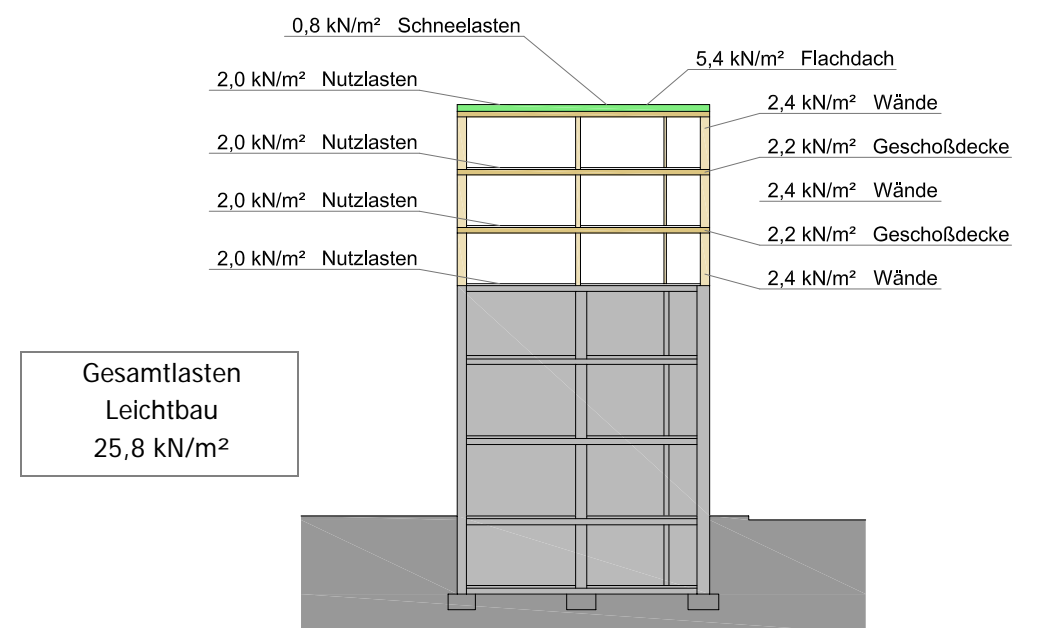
Schnitt durch den dreigeschoßigen Aufbau in Leichtbauweise
